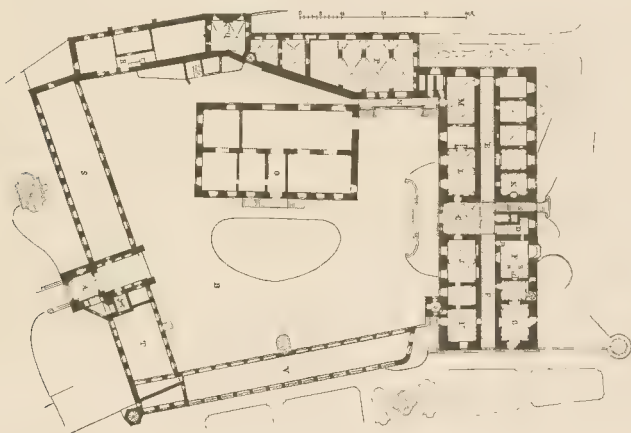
Grundriss des neuen Schlosses zu Baden. Nach Luebke
